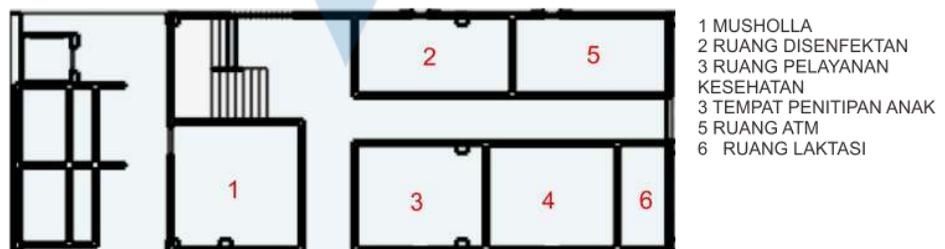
Zonasi Ruang Pengelola Servis Lantai 2
